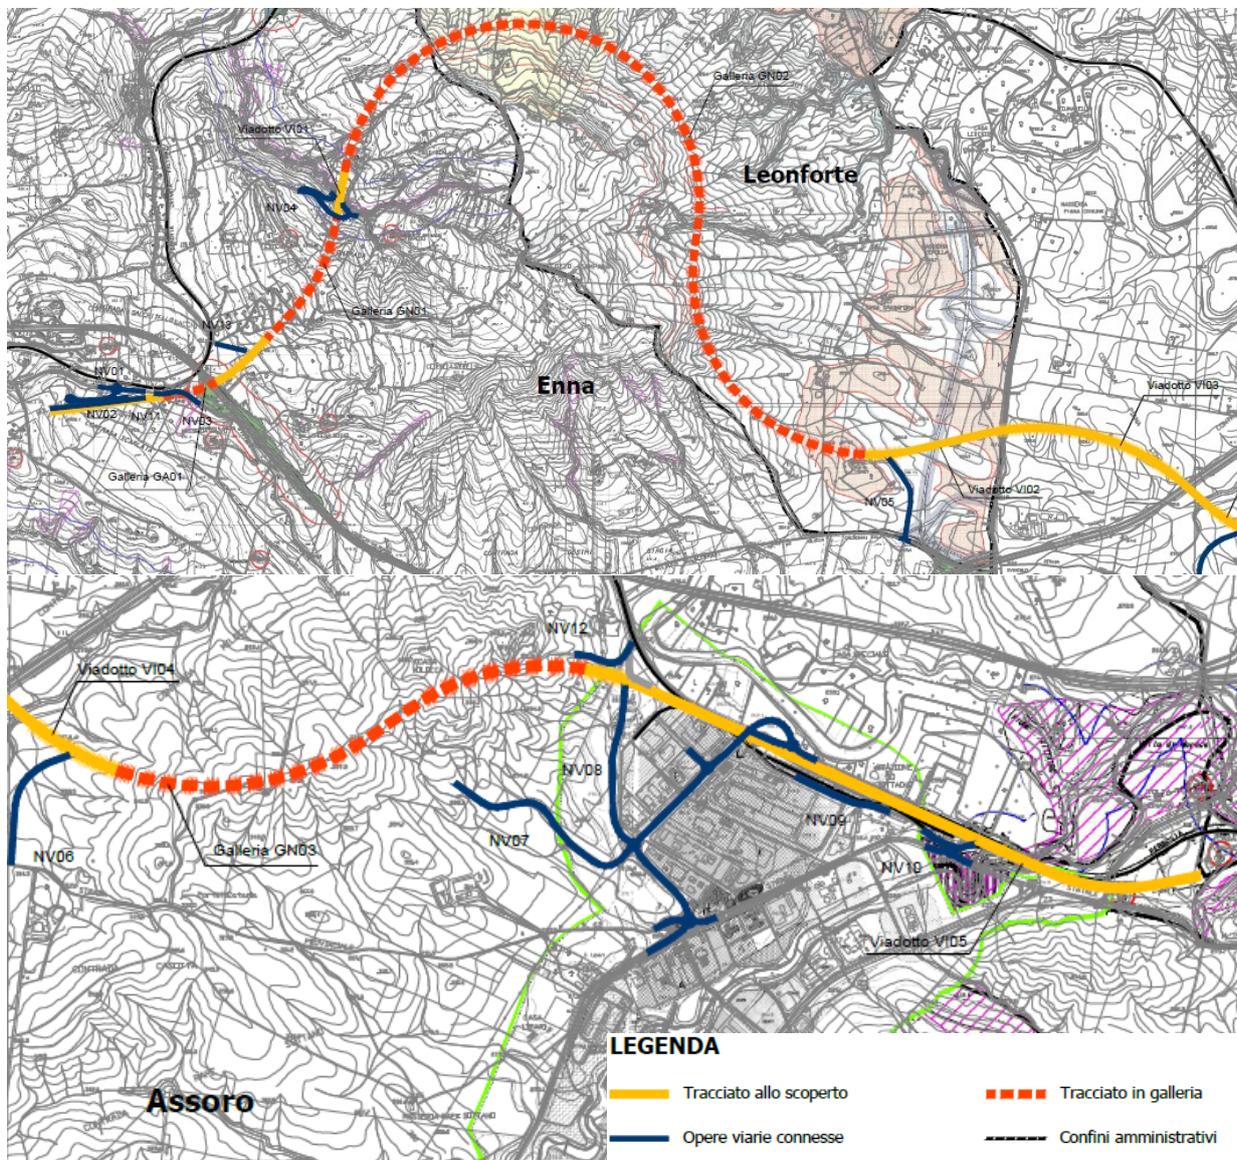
Tracciato planimetrico con individuazione tratti in galleria e all'esterno
